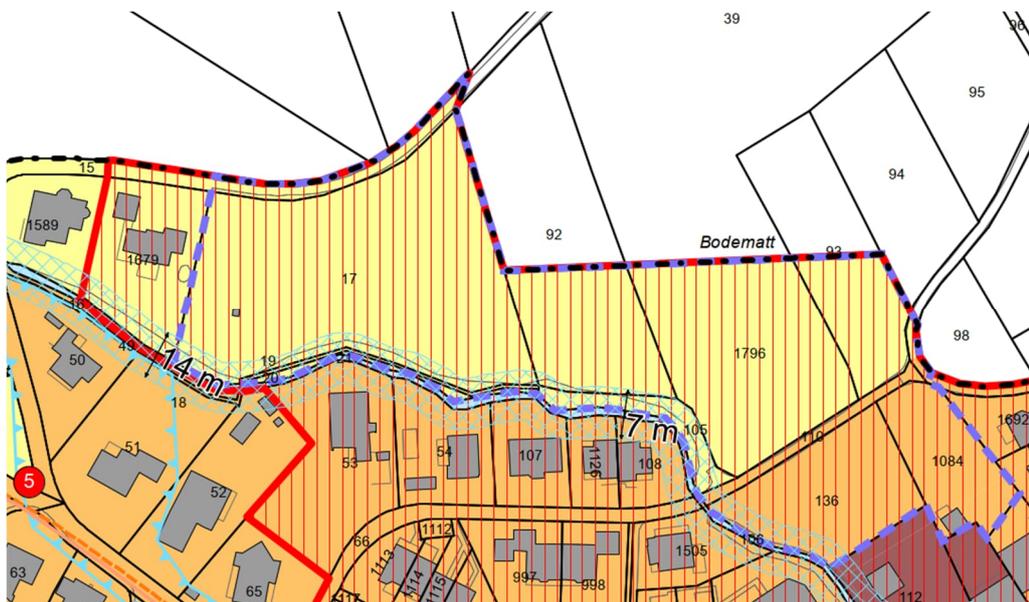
Ausschnitt Bauzonenplan mit Gebiet «Dörrmattraï» und Gestaltungsplanpflicht (violette Bandierung)
